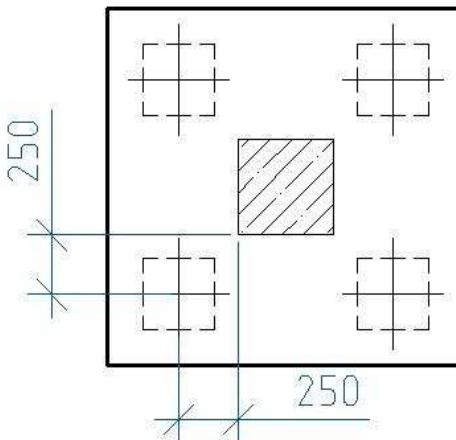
Схема к расчету ростверка на изгиб
